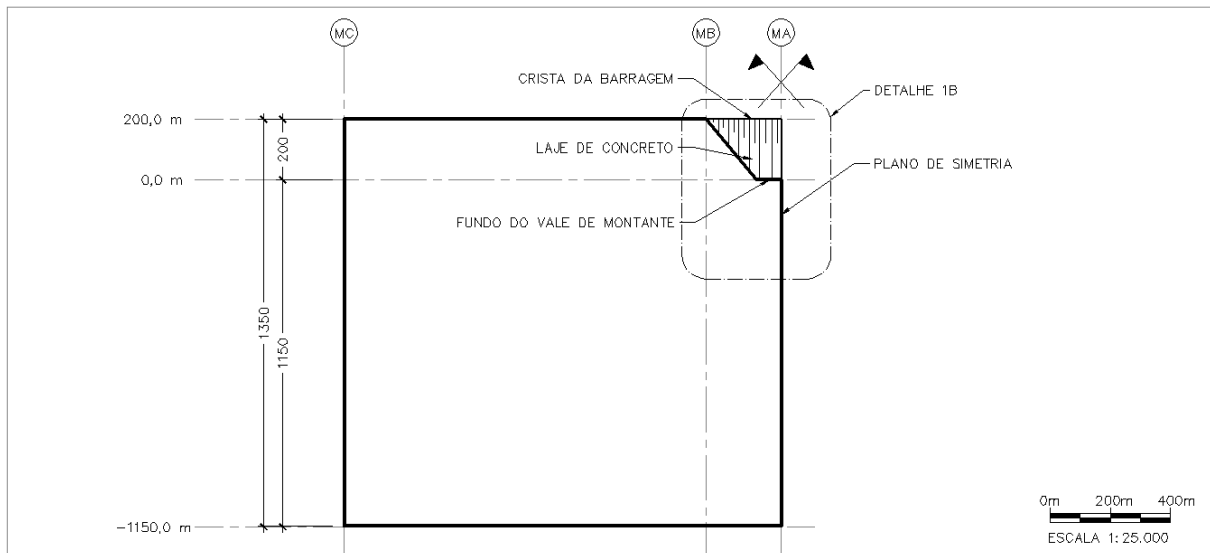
Corte B com o perfil no plinto. Escala 1:25.000.
